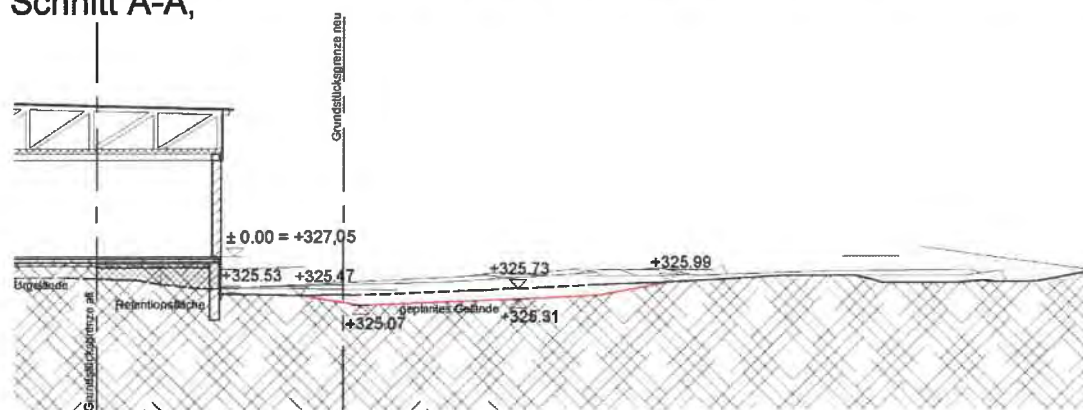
Lageplan Retentionsausgleich (ohne Maßstab)
